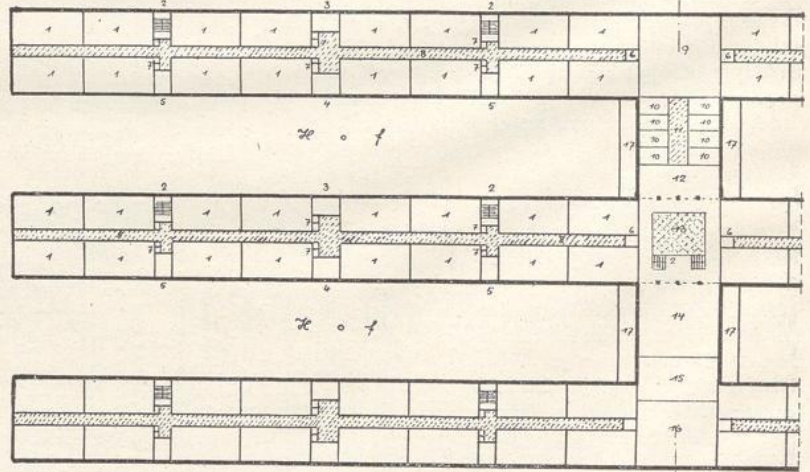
Grundrißschema für das Gemeinschaftswohnhhaus (1:1000)
